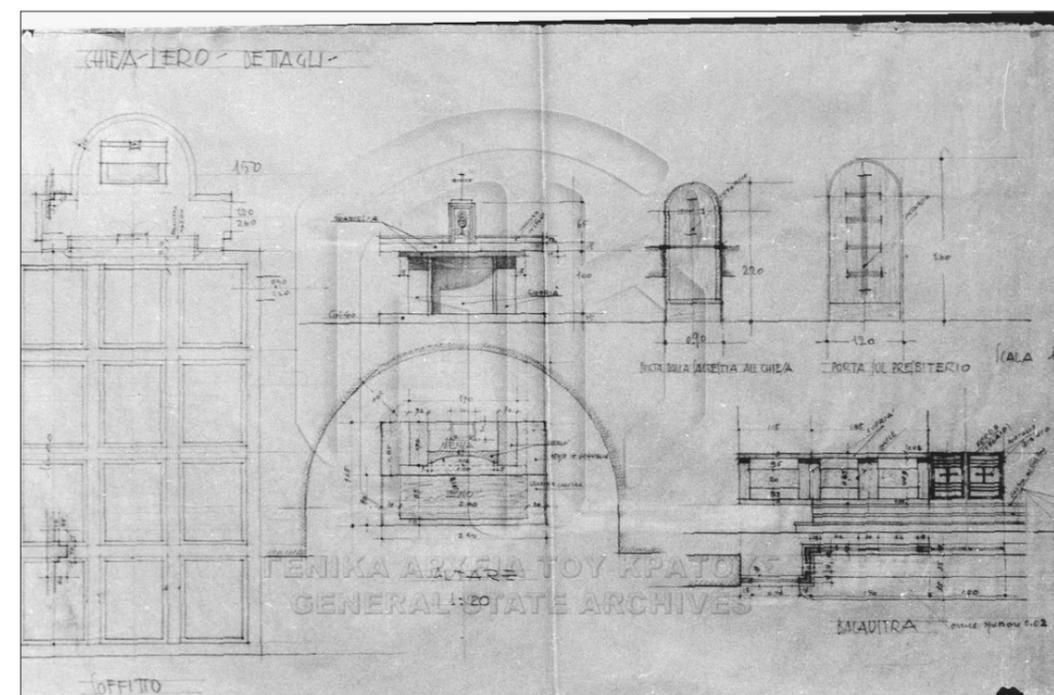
chiesa, pianta soffitto sc. 1:100 e dettagli sc. 1:20
